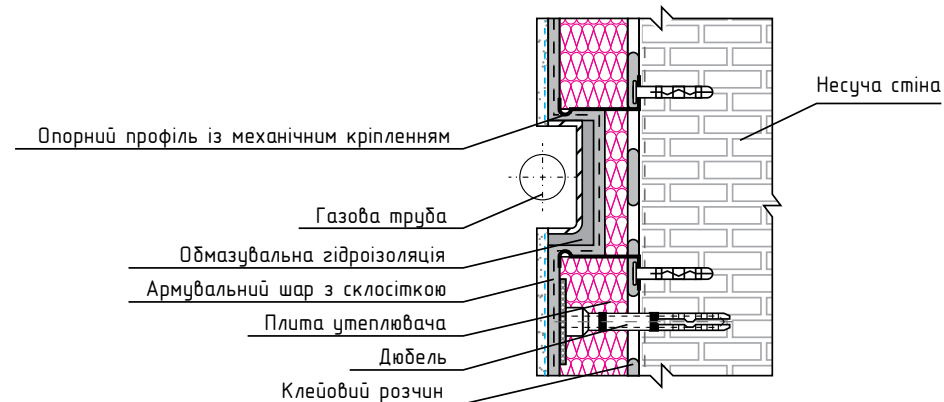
Влаштування теплоізоляції на фасаді з газовою трубою
